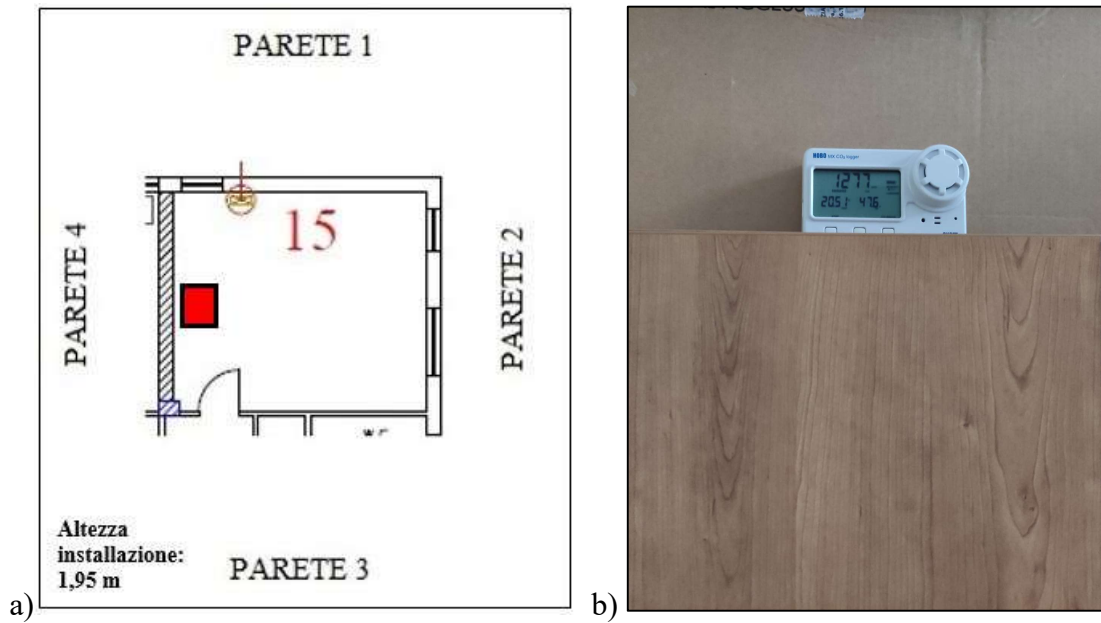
Posizione acquirente in pianta (a) e in foto (b) Aula 15 (Aula Informatica)
